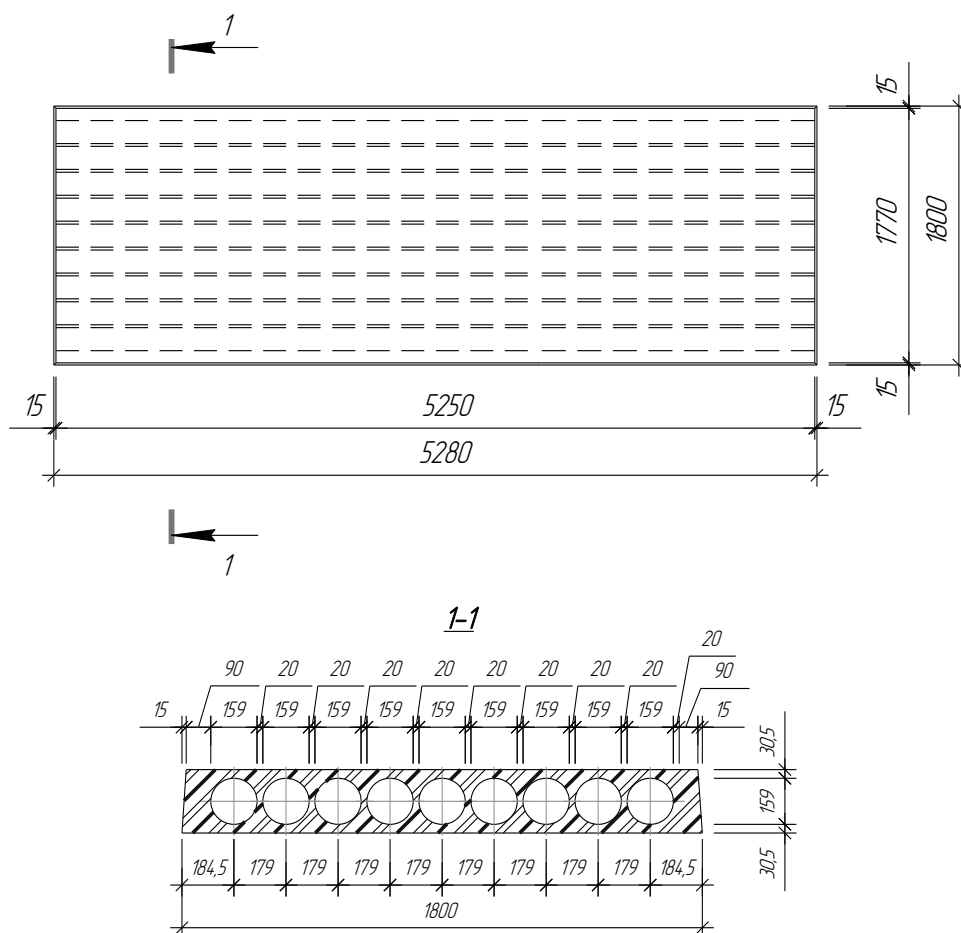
Пример опалубочного чертёжа плиты перекрытия.
